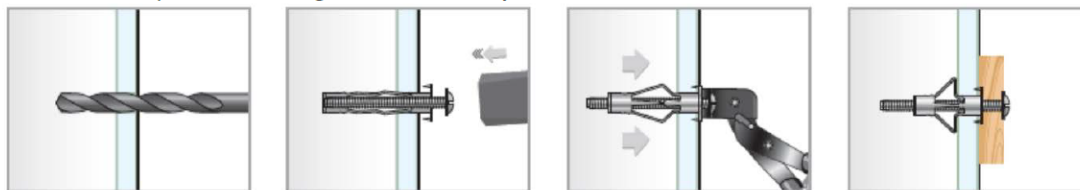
Fixation de l'équipement sur un mur en plaques de plâtre
